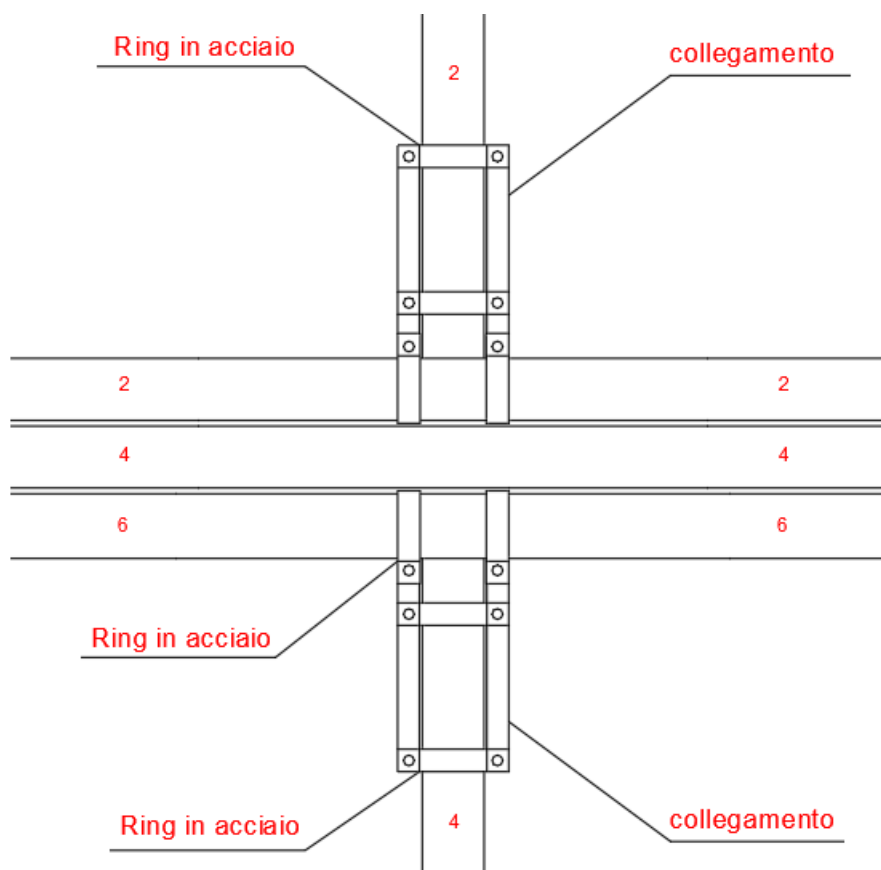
Prospetto del giunto tra il culmo centrale dei pilastri con i culmi centrali delle travi.
